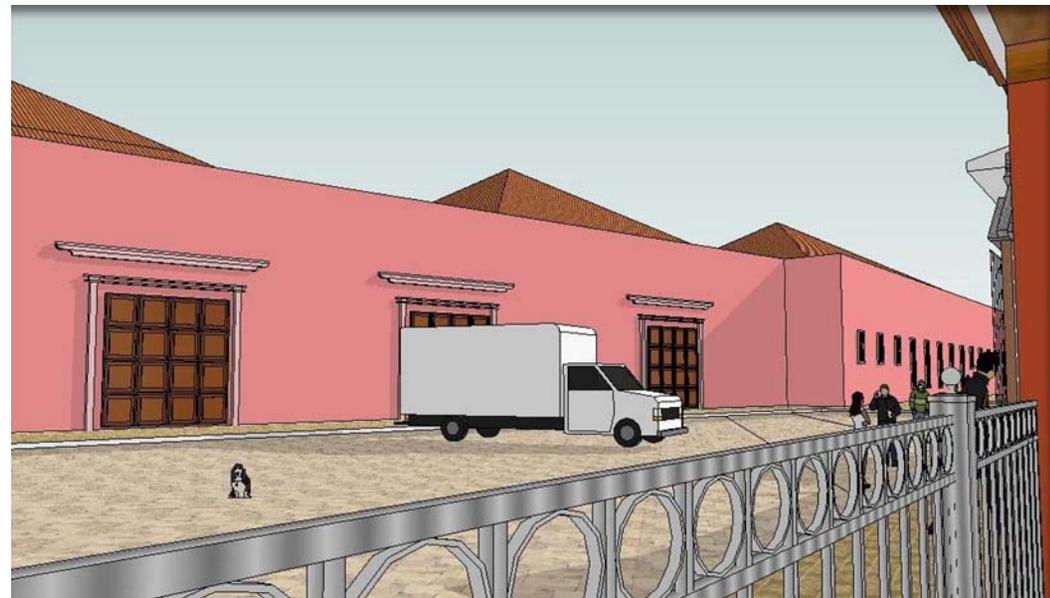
Perspectiva - Vista Norte - Av. Irineo Chacón
